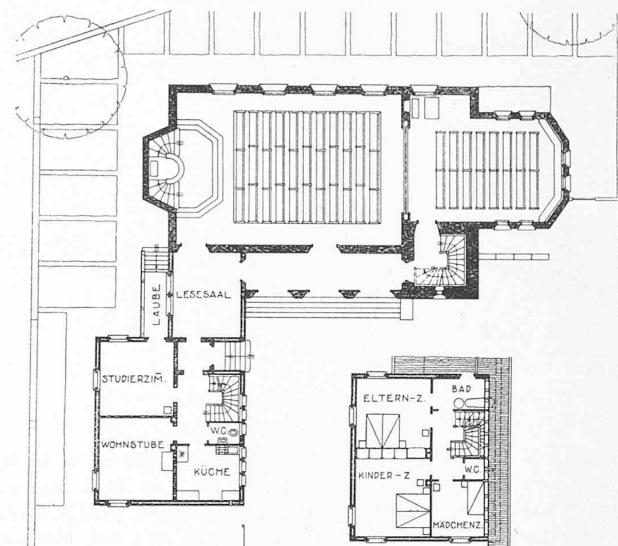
Grundrisse von Kirche und Pfarrhaus. — Masstab 1:400.
